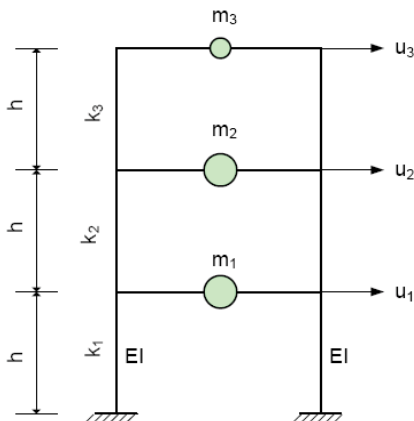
Расчетная динамическая модель здания, работающего на сдвиг
